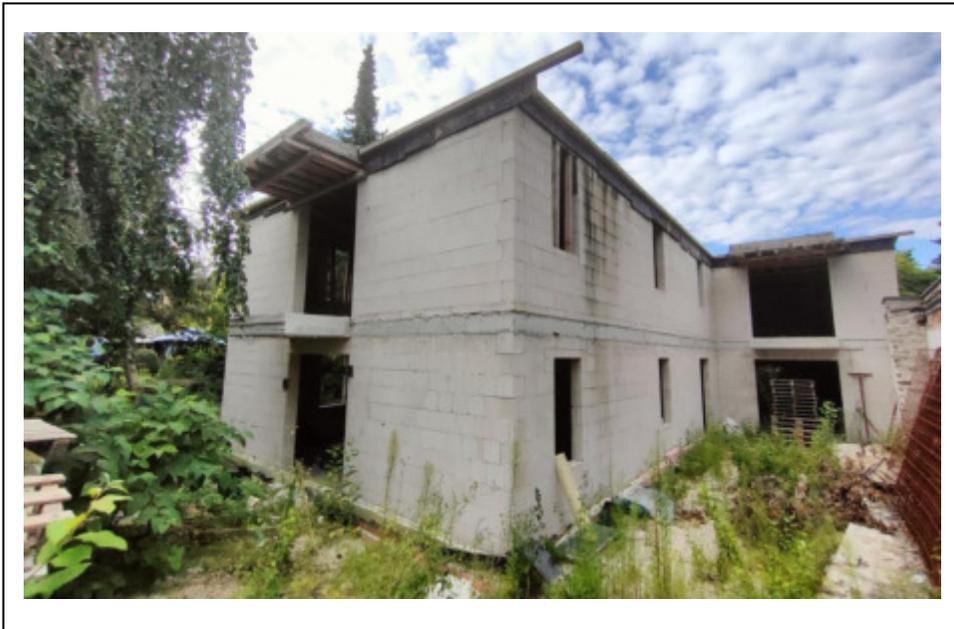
o Links und rechts: Rückansichten (östliche Gebäudesite)
